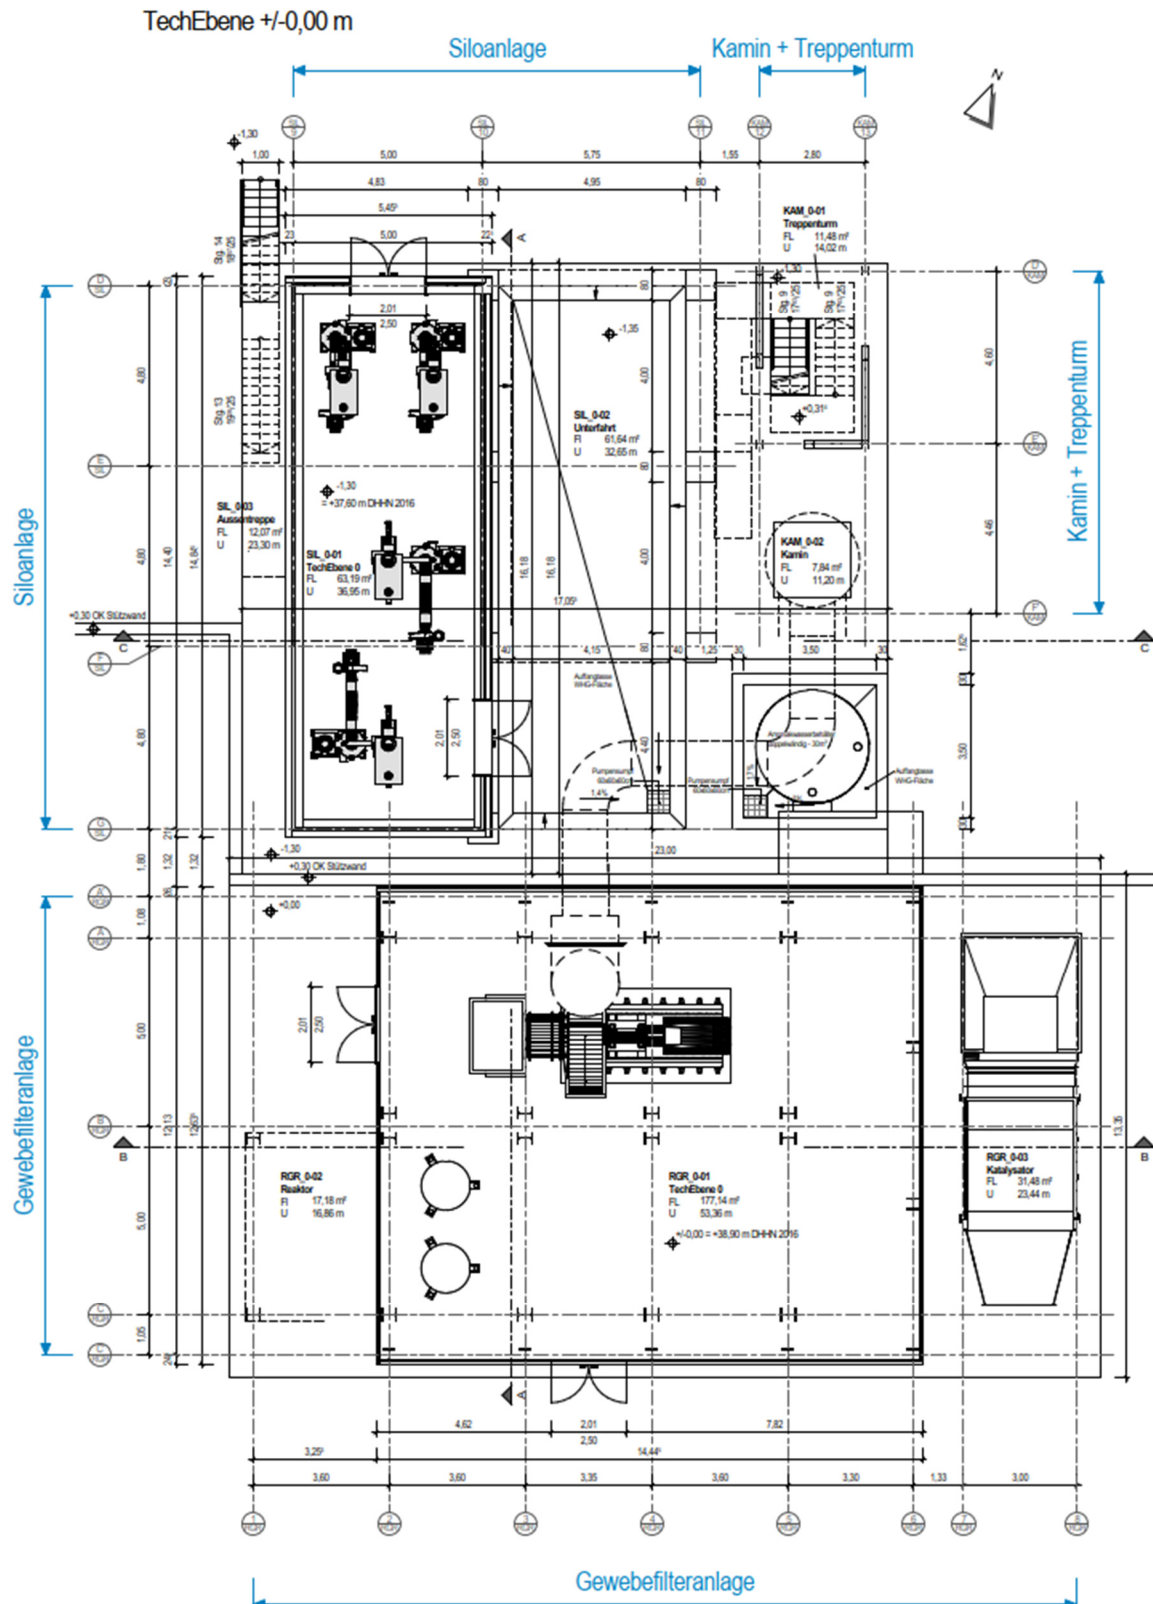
Auszug Grundriss Ebene 0 m - Fundamentübersicht
